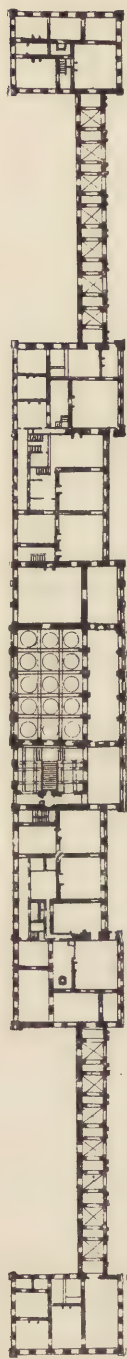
Schloss Schleissheim. Grundriss.
